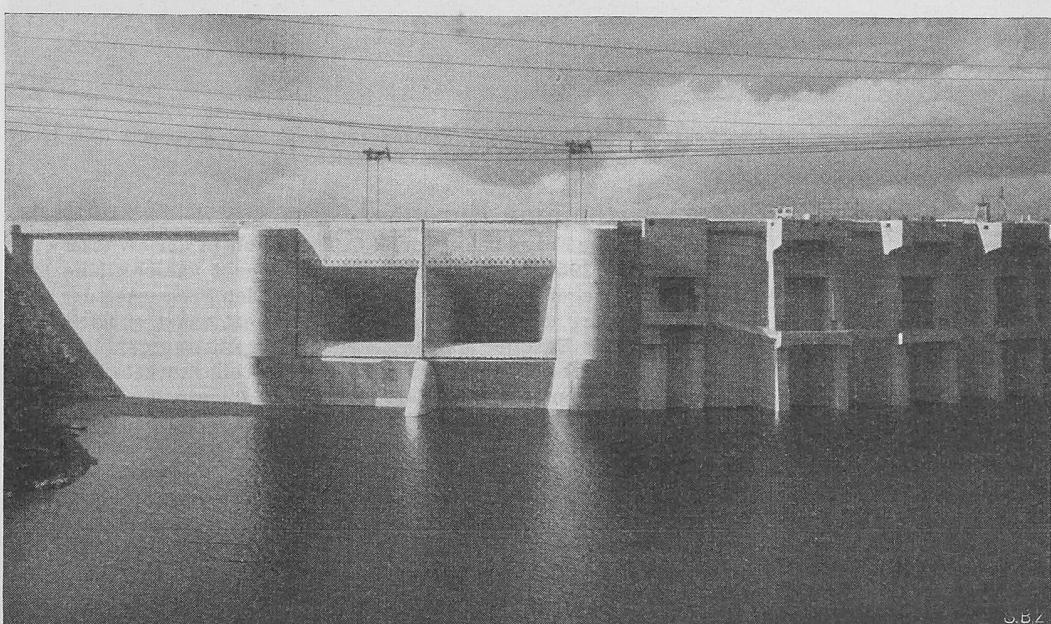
Einlauf zum Hochwasserüberfall, rechts Aufbauten über Grundablass und Wasserfassungen. 11. November 1950
